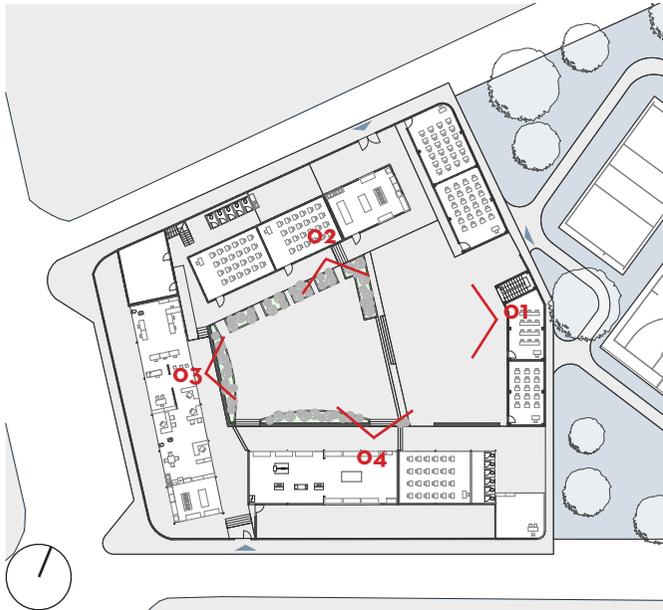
Planta de referencia. Fuente: Elaboración propia (2025).
